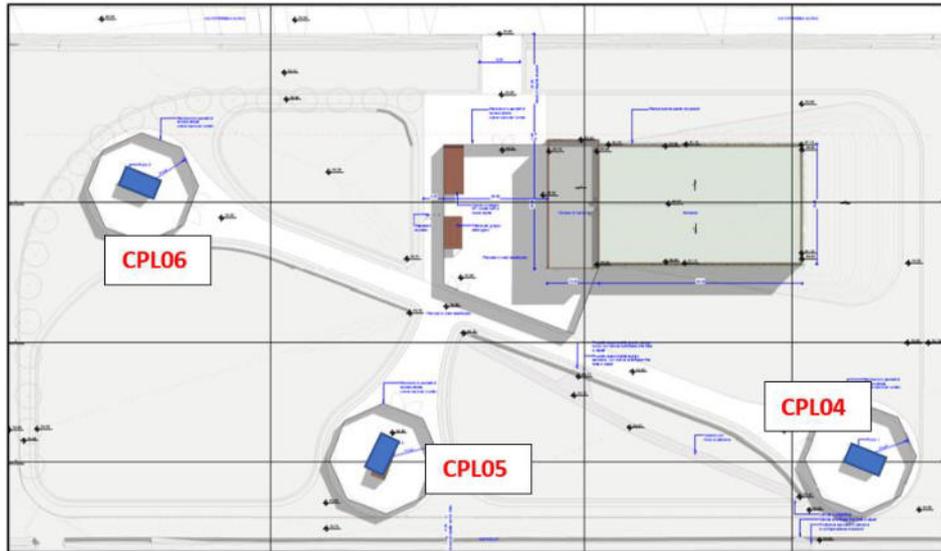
Planimetria centrale con in blu i pozzi in progetto.
